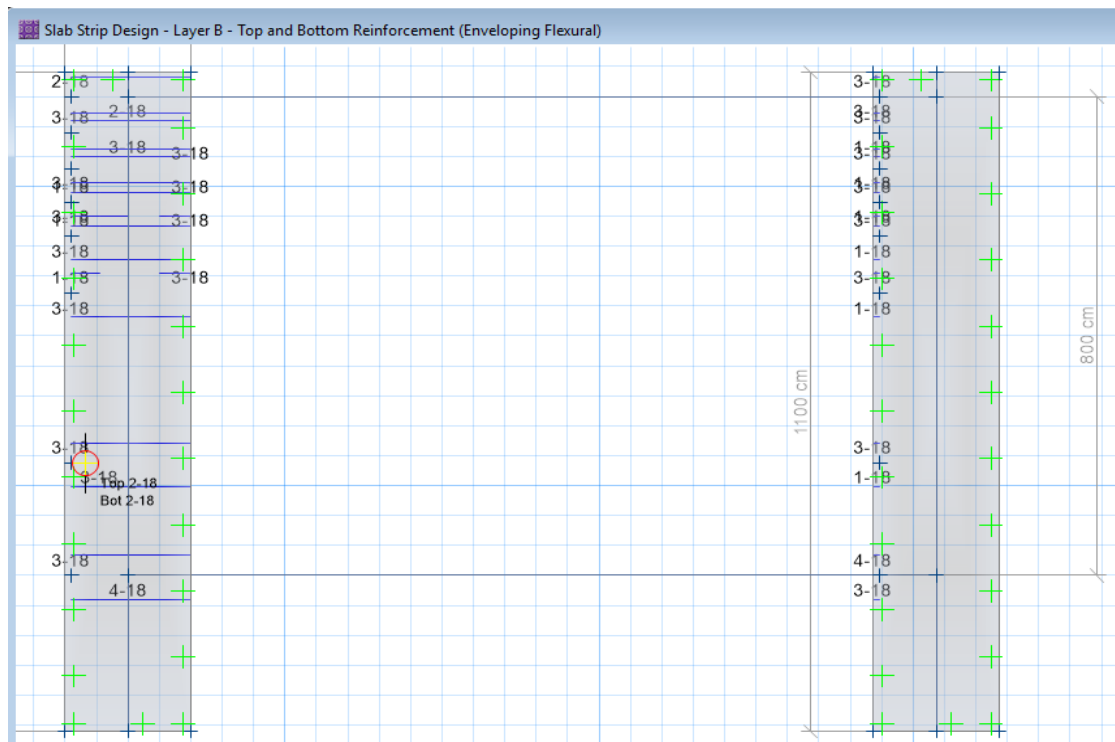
Acero Transversal en zapatas corridas de la cimentación de la carga en caliente
